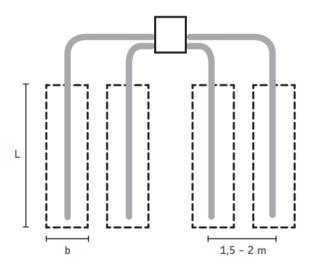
Nomenclatura de las dimensiones de las zanjas de infiltración.
